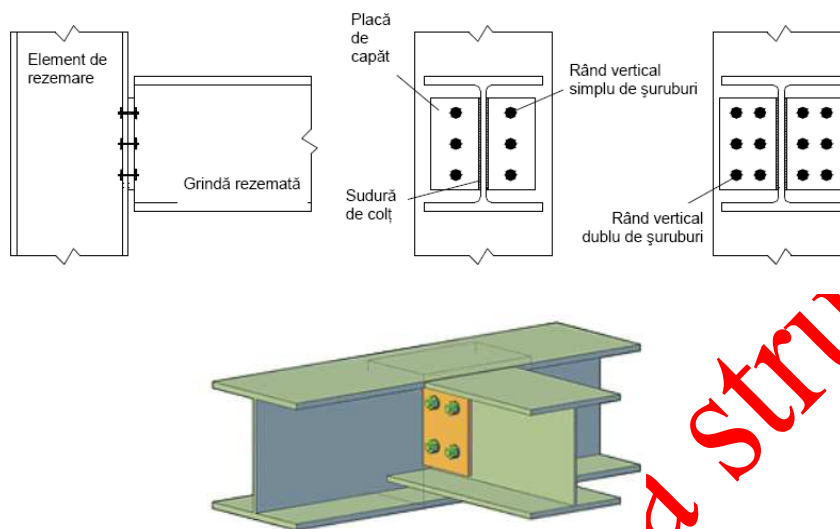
Îmbinări cu placă de capăt redusă [13]
